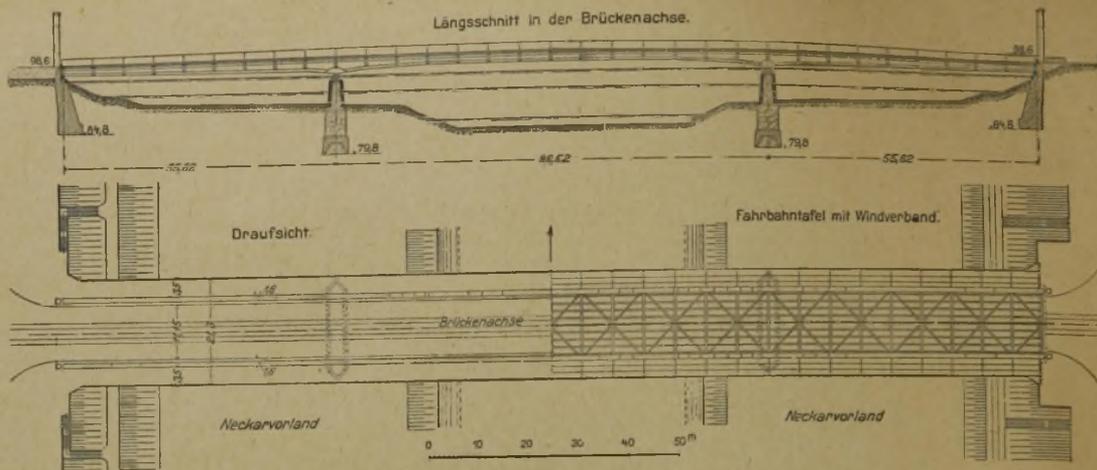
u. 7. Aufriß und Grundrisse der Brücke.
